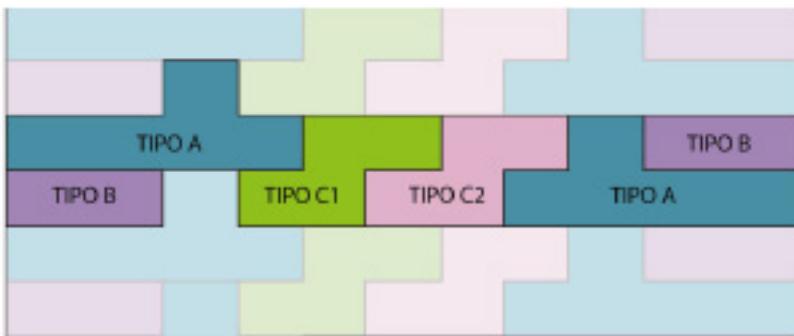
Corte esquemático do pavimento-tipo duplo (sem escala)
